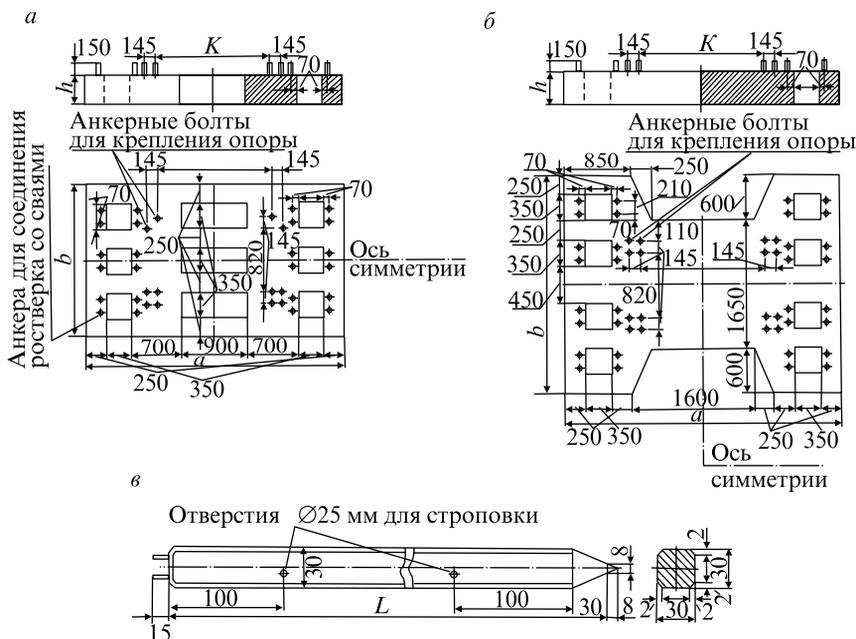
Железобетонные ростверки: *a* — П 45,65/15, ПА 45,65/15; *б* — ПА 45,65/20, П 105/20, П 150/20; *в* — железобетонная свая; *L* — длина сваи
